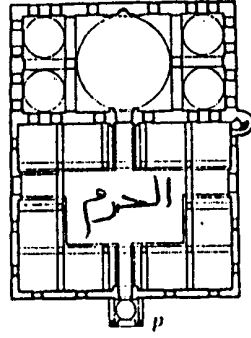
مسقط أفقي لجامع المرادية بيغداد
